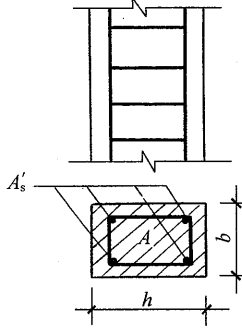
配置箍筋的钢筋混凝土轴心受压构件截面
